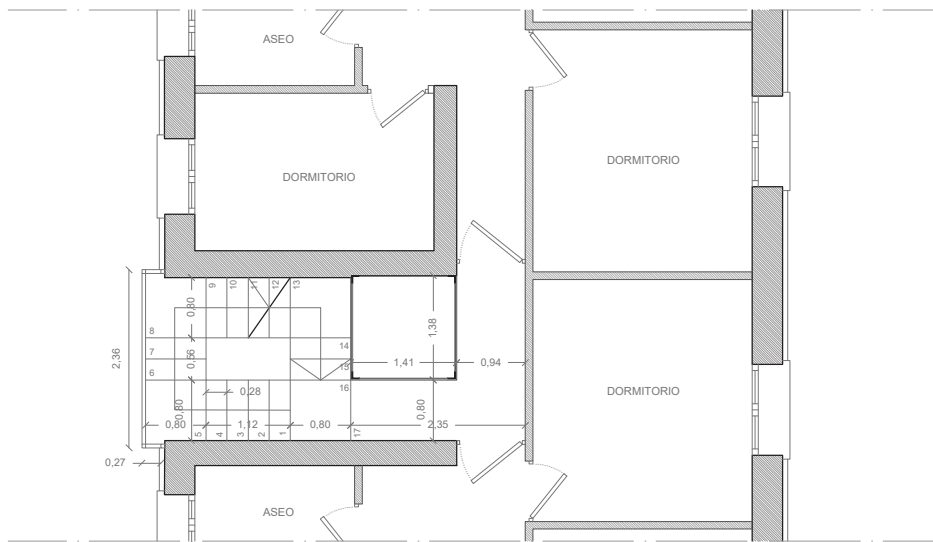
Zoom núcleo planta segunda (e: 1/100).
